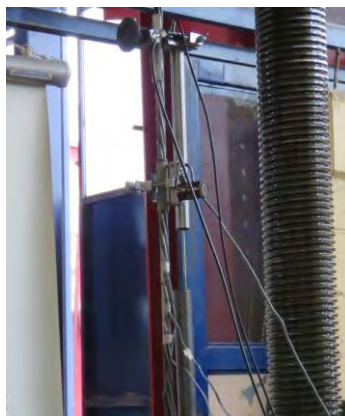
Colocación del LVDT en espécimen de prueba
